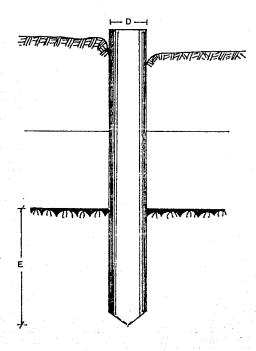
PILOTE DE PUNTA CON EMPOTRAMIENTO,
